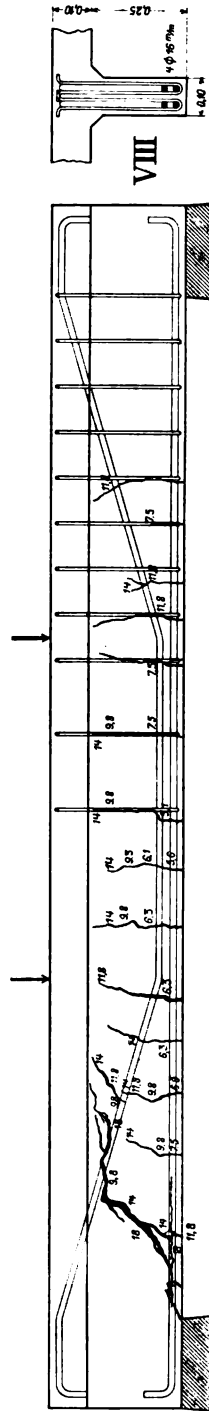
Balken VIII, Bruchlast 23,4 t.
